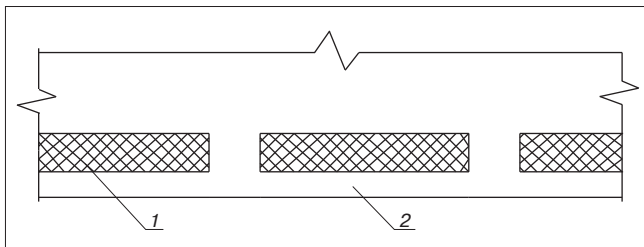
Существующая опорная конструкция: 1 – утеплитель; 2 – опорный железобетонный пояс
